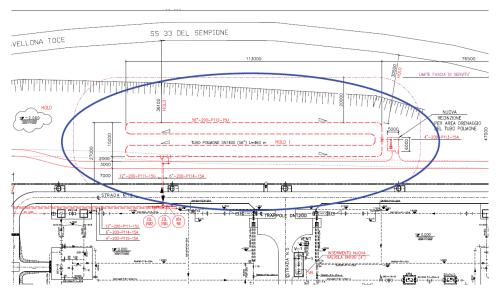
Planimetria impianto con ubicazione del tubo di recupero gas
